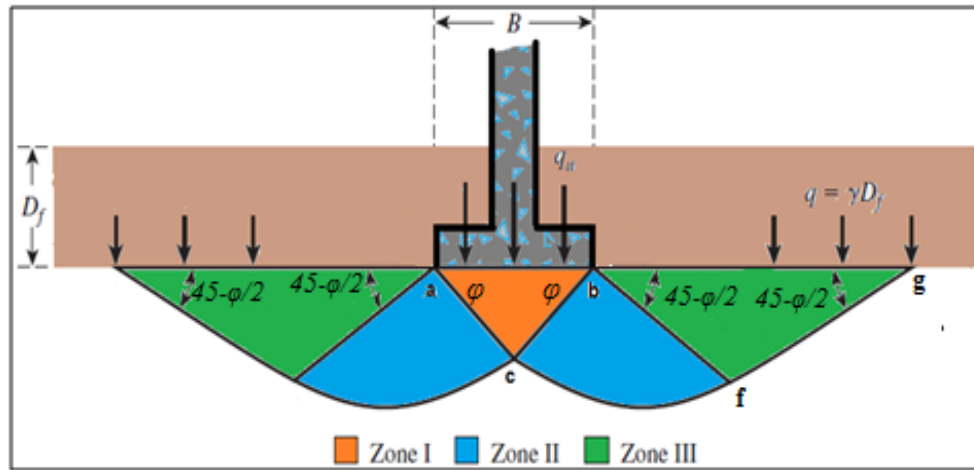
Mécanisme de rupture d'une semelle filante Terzaghi (1943)
